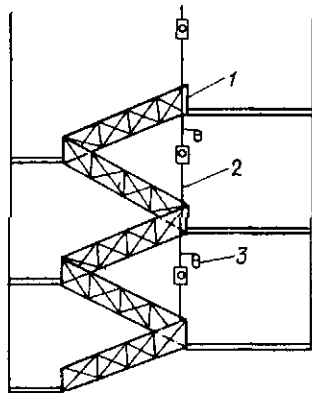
Инвентарный стояк для освещения строительных работ внутри зданий
